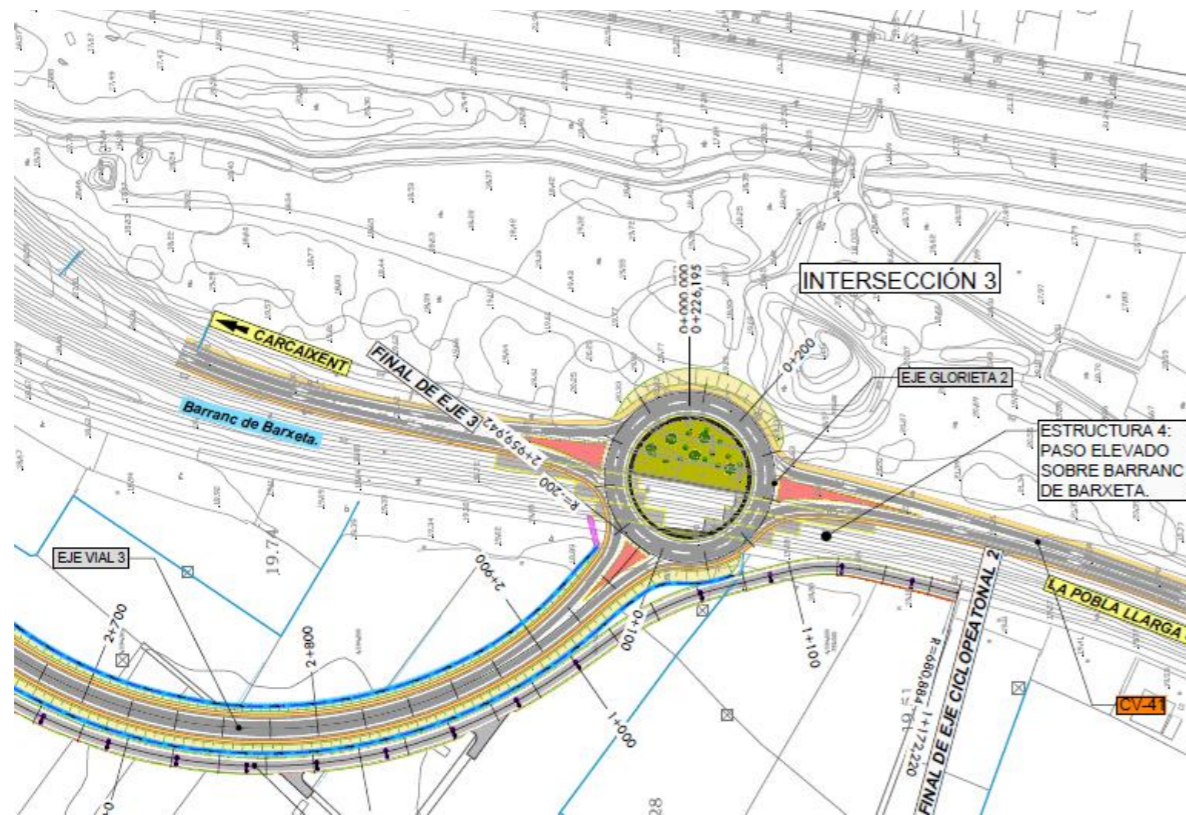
Planta de la rotonda en su conexión con la Cv-41 y cruce con el Encauzamiento del Barranco de Barxeta.
